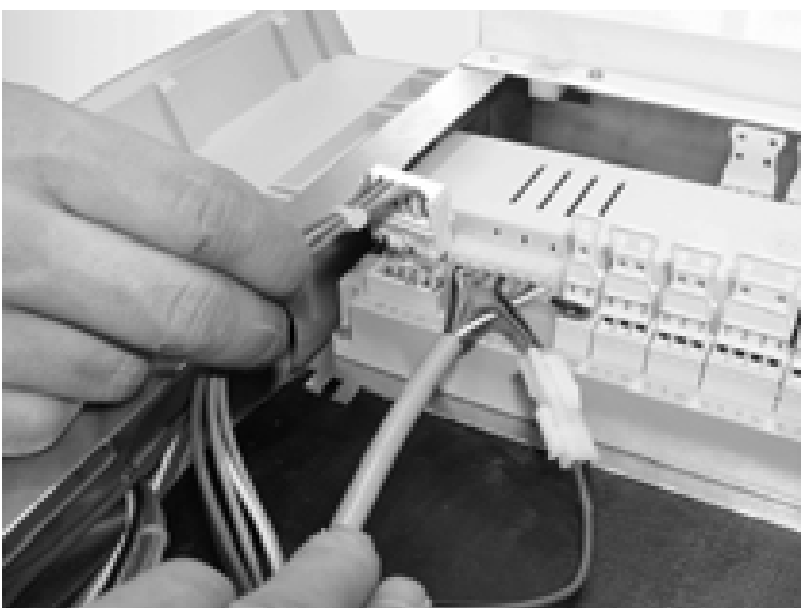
Das Kabel vom Kesselschaltfeld für die Spannungsversorgung des Kesselreglers (Steckkontakt L, PE, N, L1, S3) an der Regelung anschließen.
